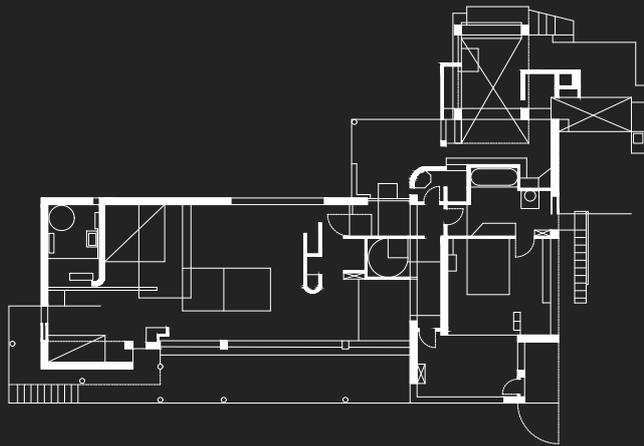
| Planta do piso 1 da E.1027 - produção própria.
